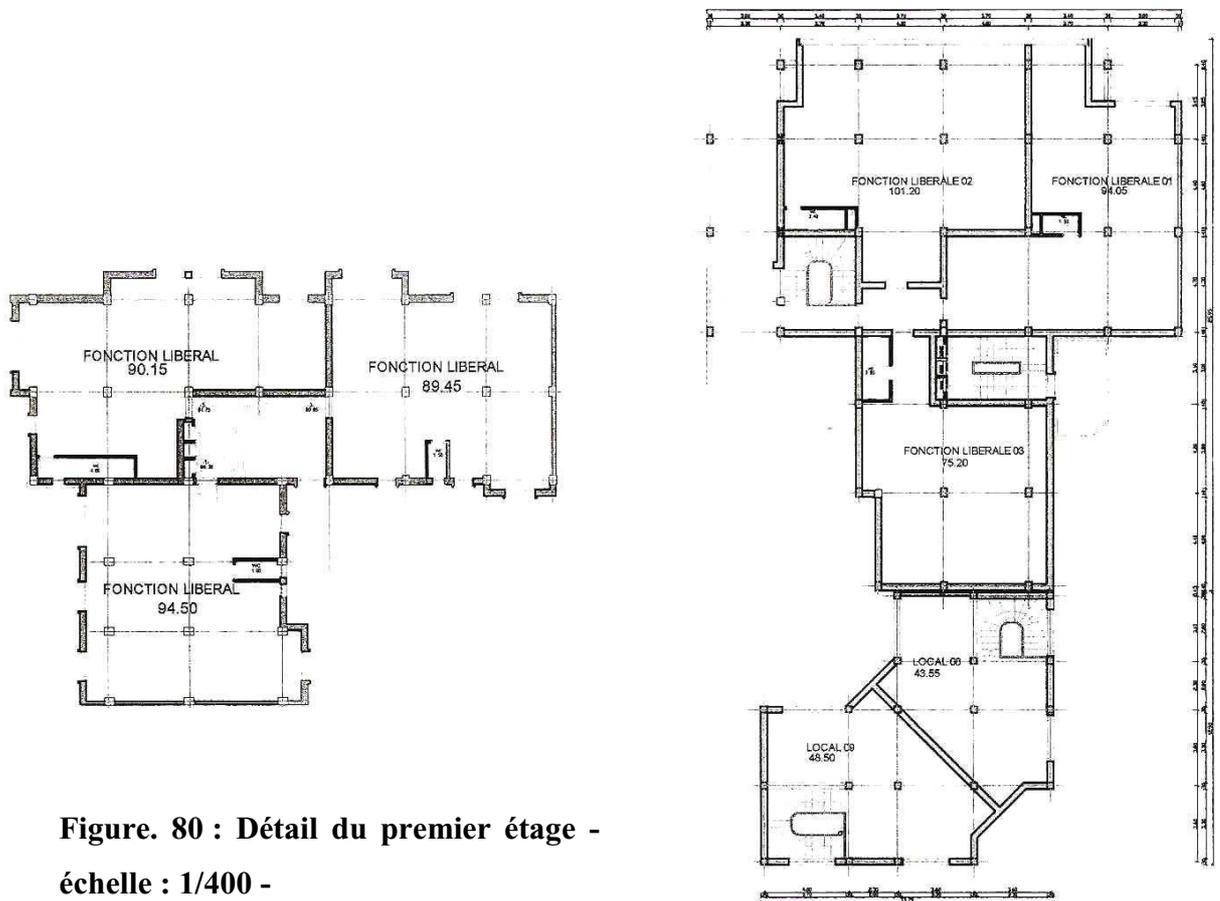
Détail du premier étage - échelle : 1/400 -
